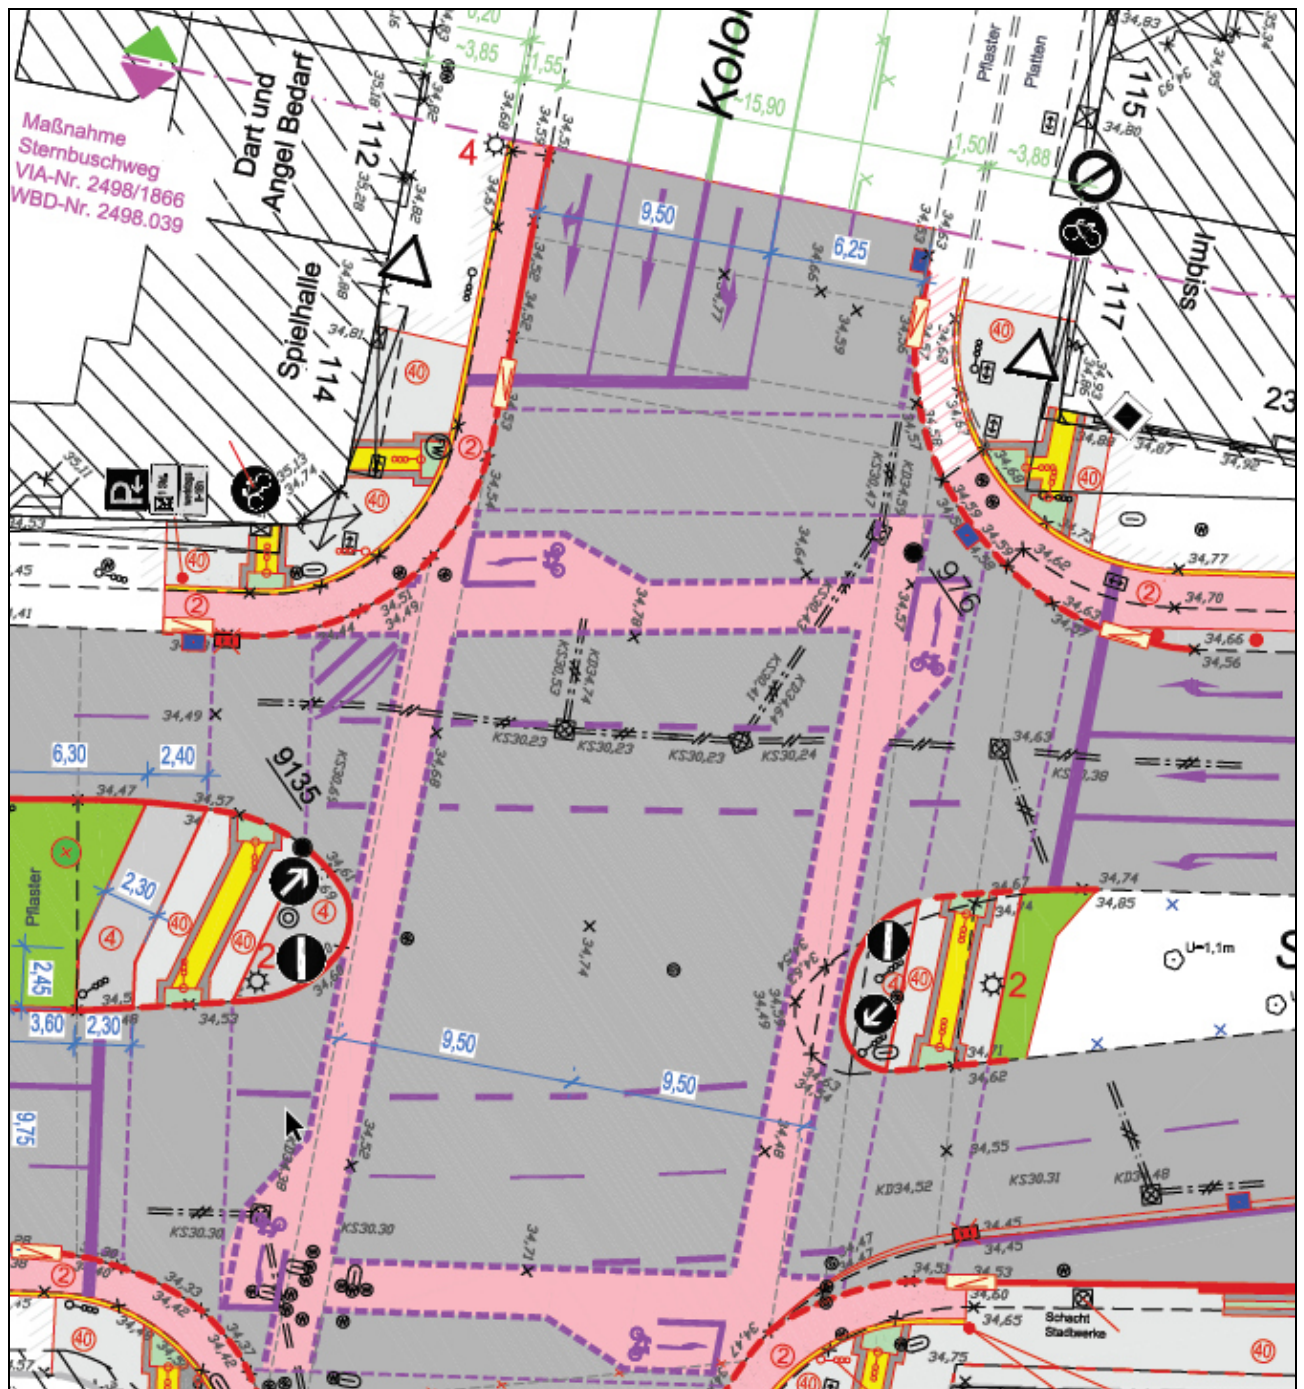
Beispiel eines Lageplans (Leistungsphase 2-3 HOAI, Separationsprinzip)
